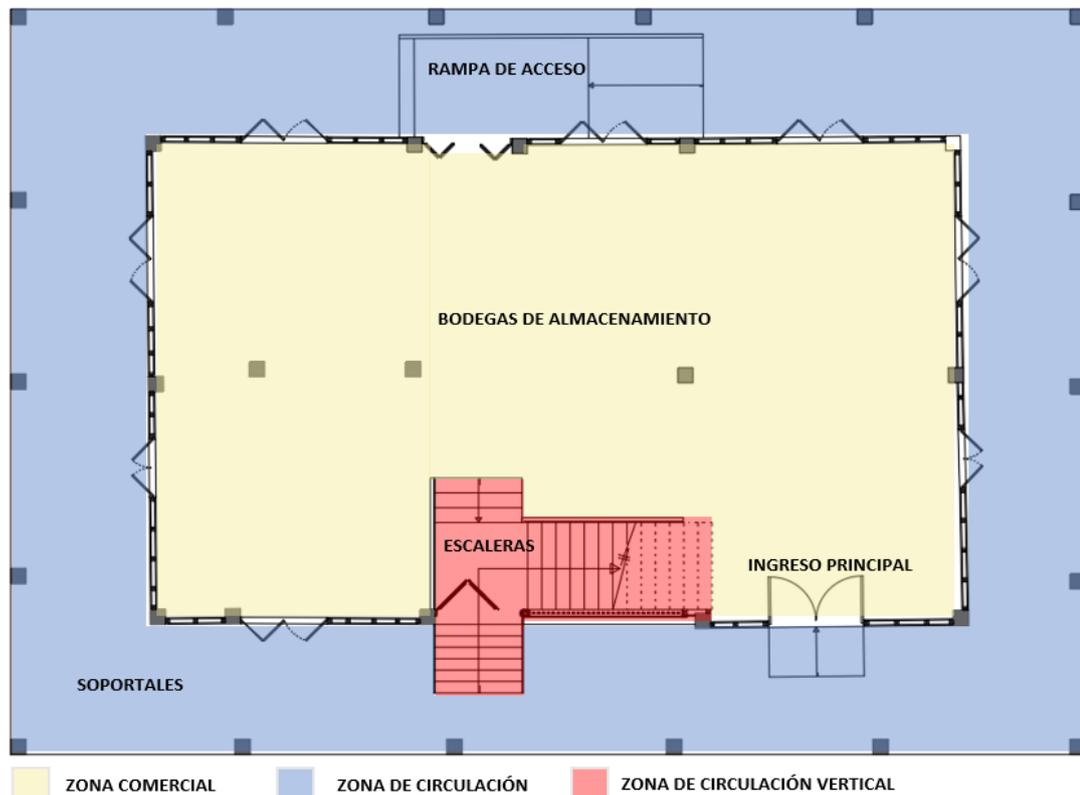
Zonificación planta baja de la Casa de Olmedo.
